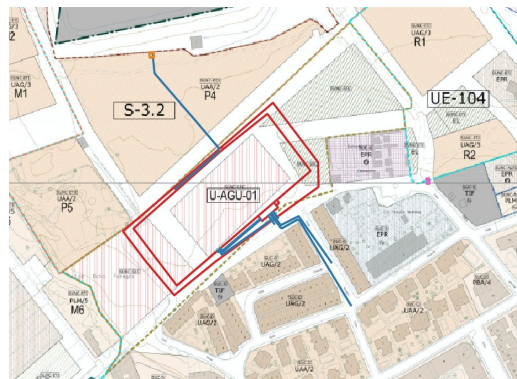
Planta sobre plano POP 01-04 y POP 01-07 del PGOU 2009
